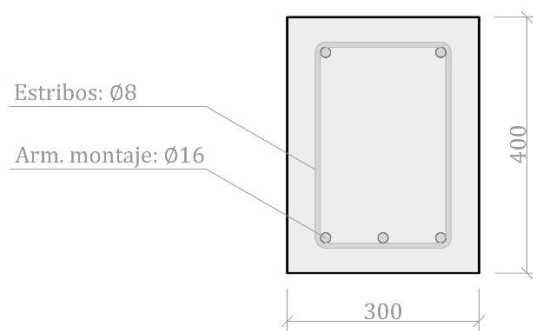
Esquema jácena de trabajo (Elaboración propia, 2025).
